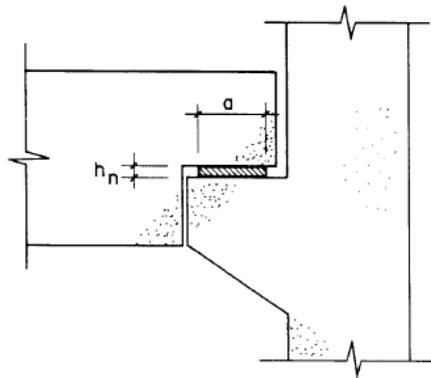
T&A Pré-fabricados – Estruturas em esqueleto Hadade (2016).
